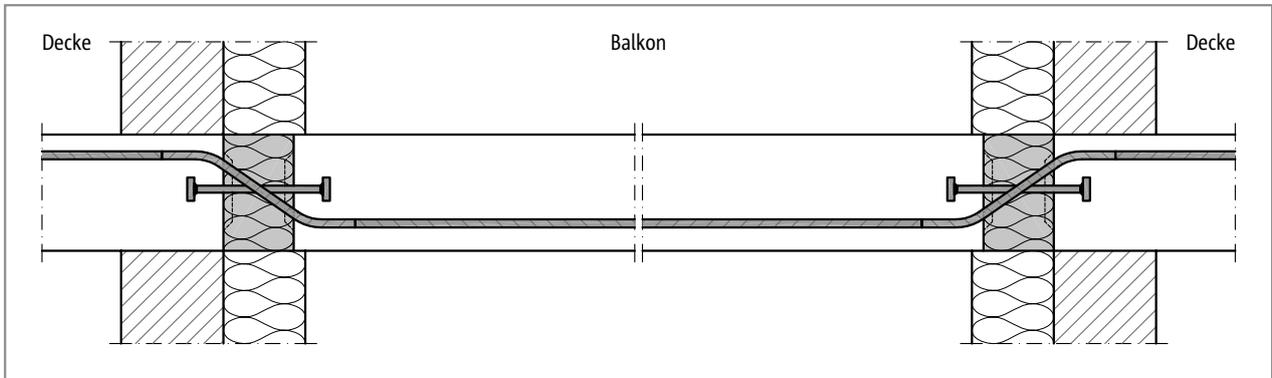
Schöck Isokorb® Typ QPXT: Anwendungsfall Loggia
